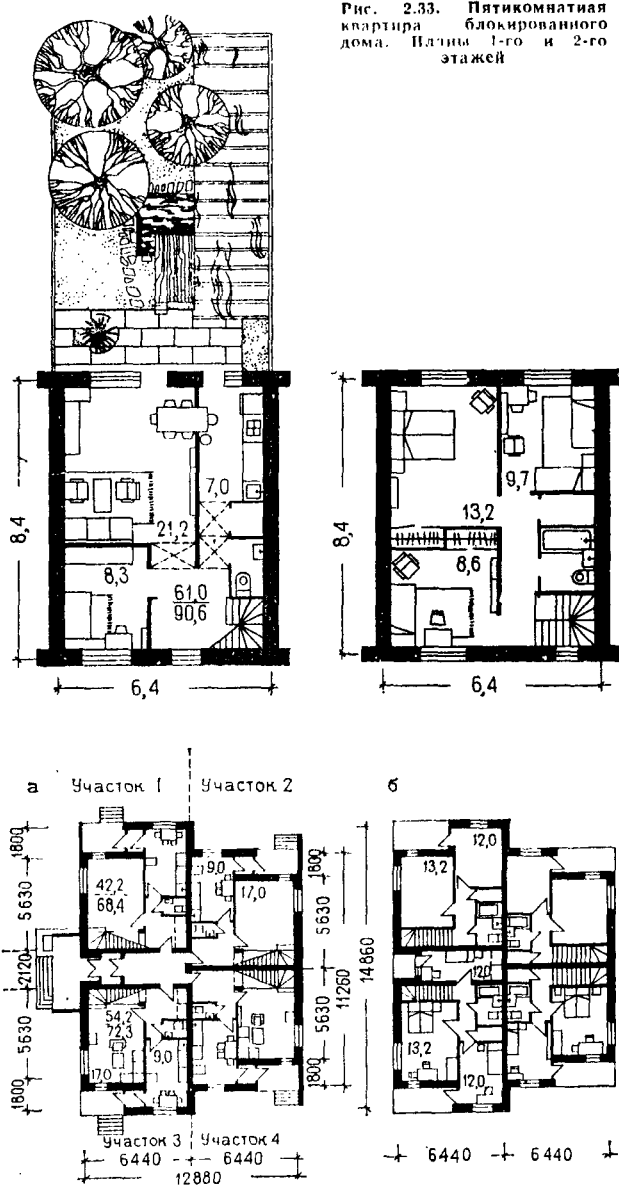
Блокированный четырехквартирный дом с квартирами в двух этажах и приквартирными участками. Планы этажей
